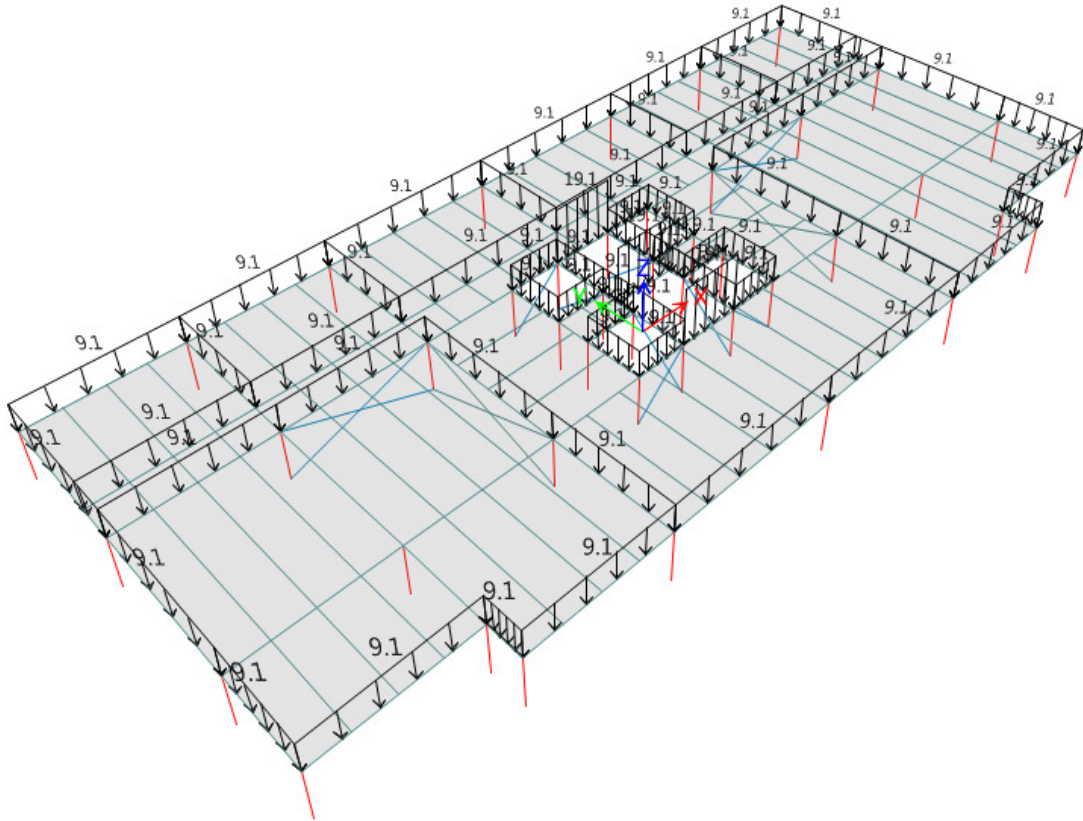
Carregamentos permanentes distribuídos do pavimento tipo aplicados ao modelo estrutural
